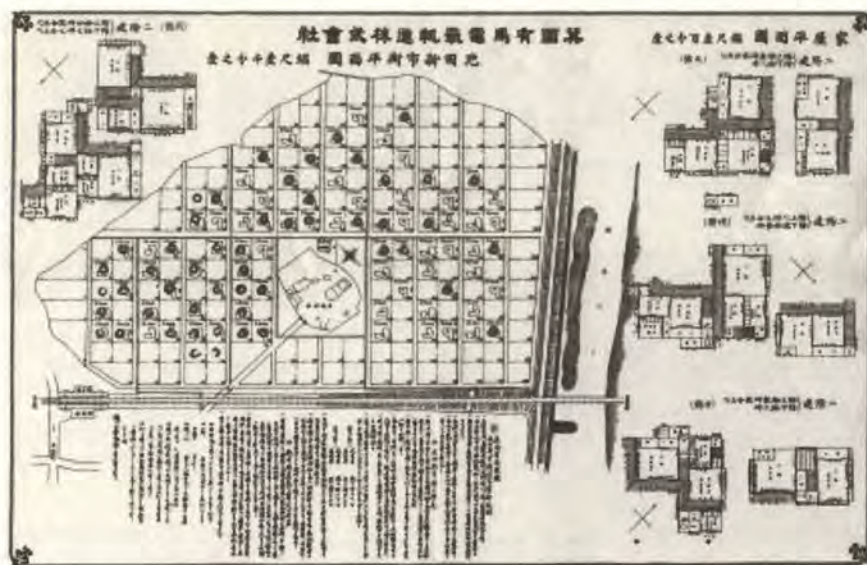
池田新市街住宅販売用配置平面図²⁸⁾
